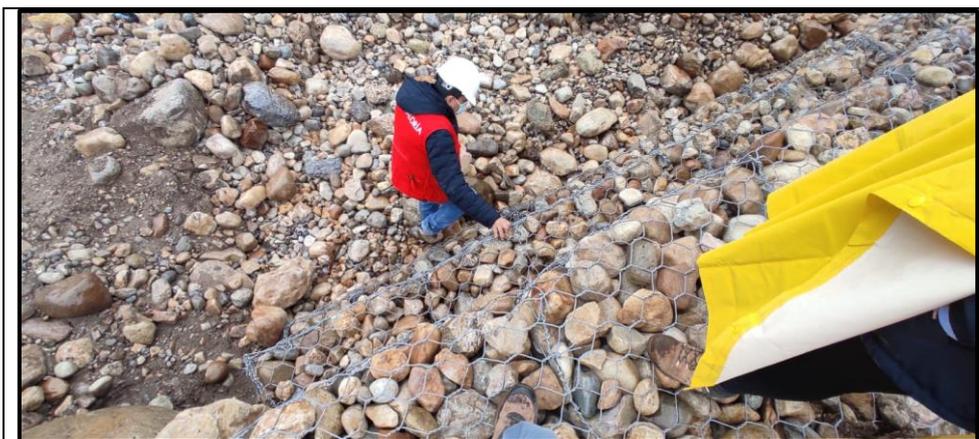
Deficiente distribución de las piedras provoca vacíos en el muro con gavión.
